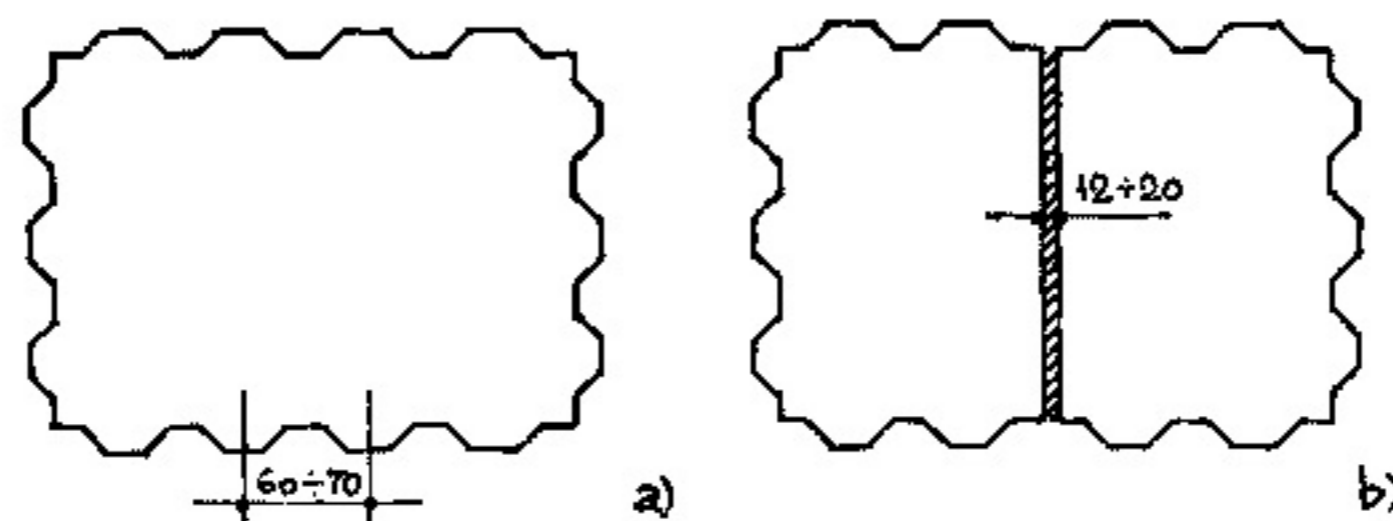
Planșee din elemente plane mari; a - panou; b - semipanouri
